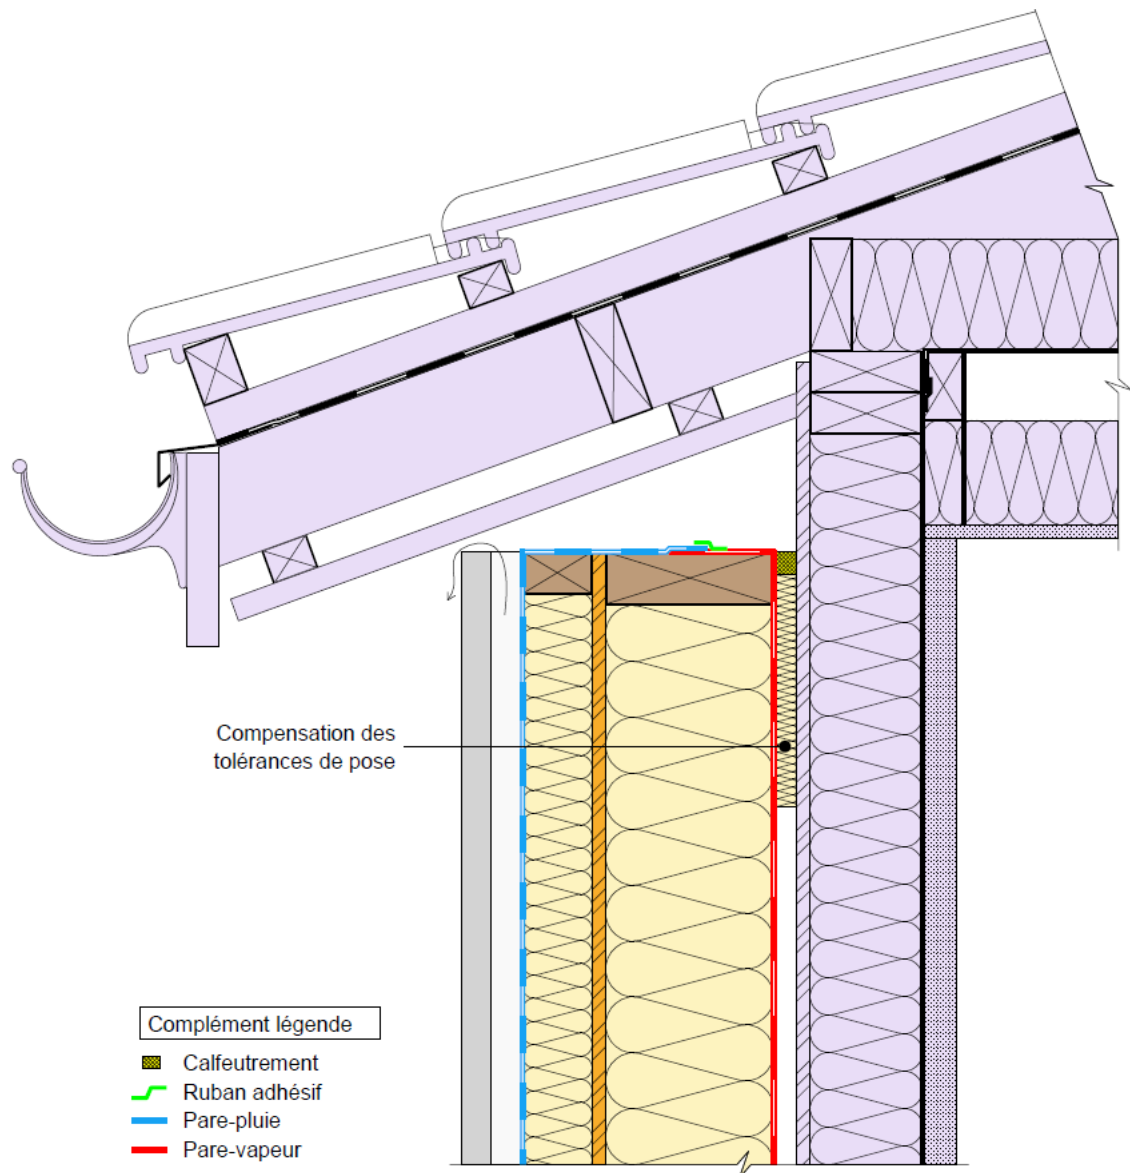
Raccordement sous débord de toiture (coupe verticale)
